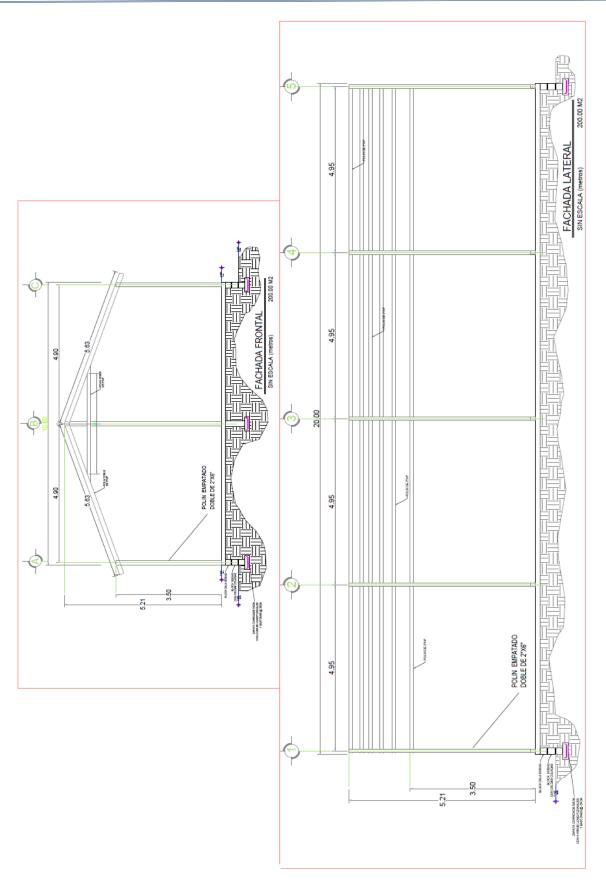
Fachada frontal y lateral de la nave de servicio para la planta de OI.
